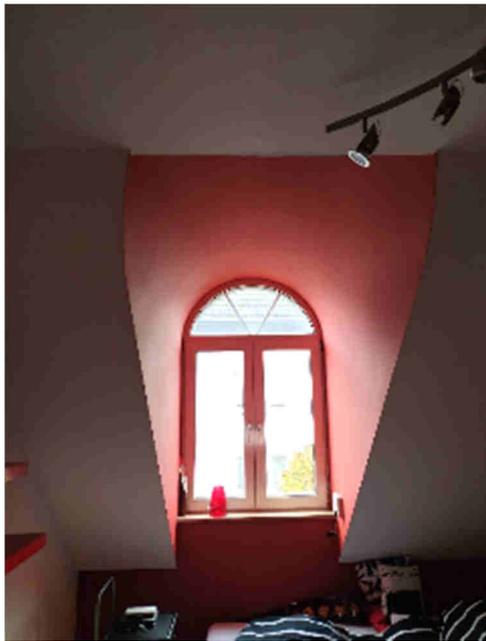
Dachgeschosszimmer mit Gaube nach Südwesten
